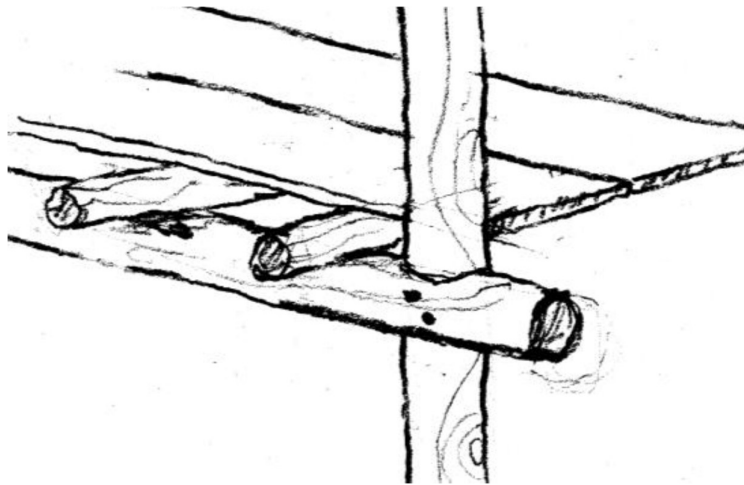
Konstruksi Tiang Rumah Suku Bajo
